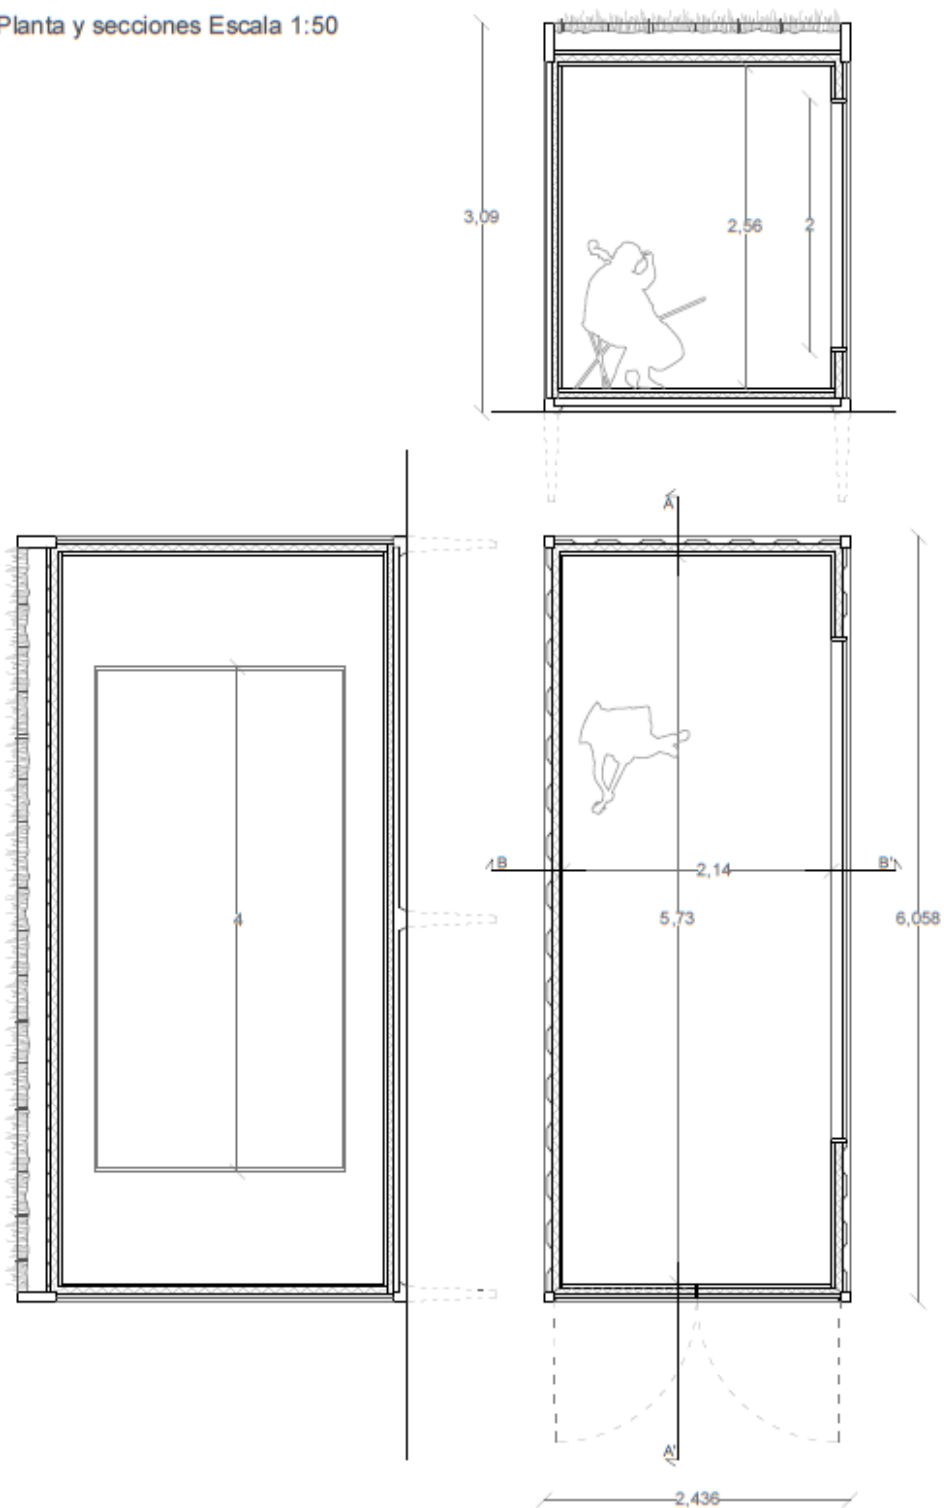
Plano de la planta y secciones del módulo a diseñar, a escala 1:50
